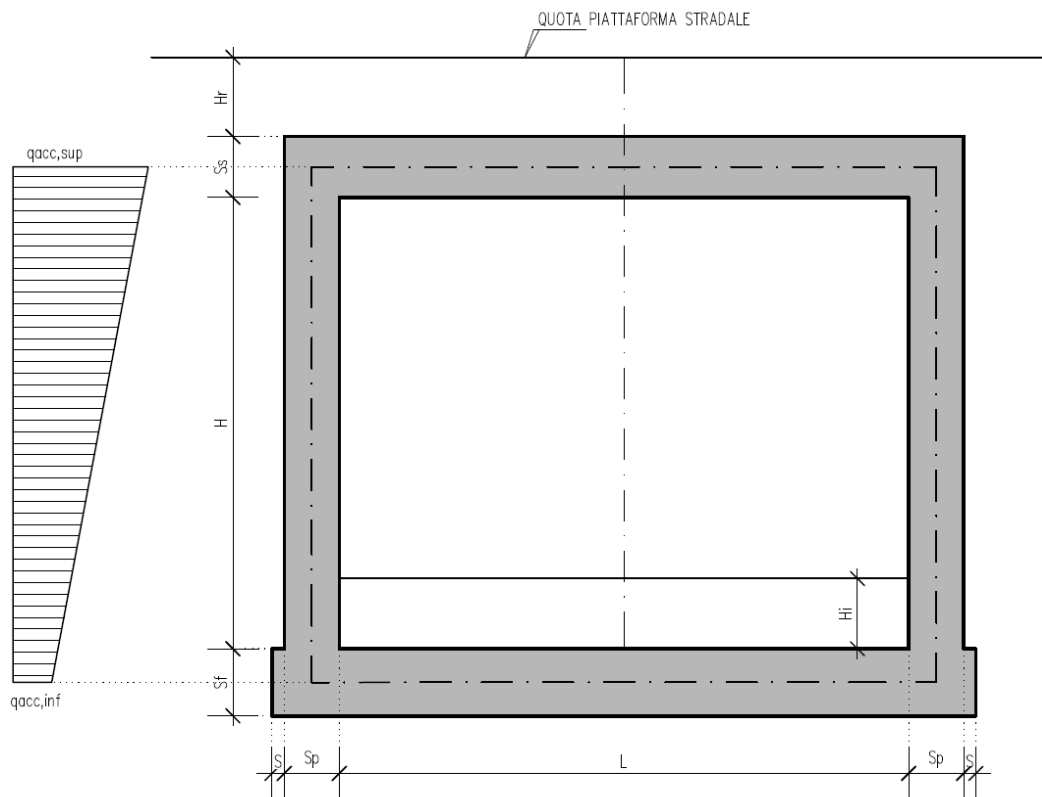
SPINTA SUL PIEDRITTO GENERATA DAL CARICO DA TRAFFICO
